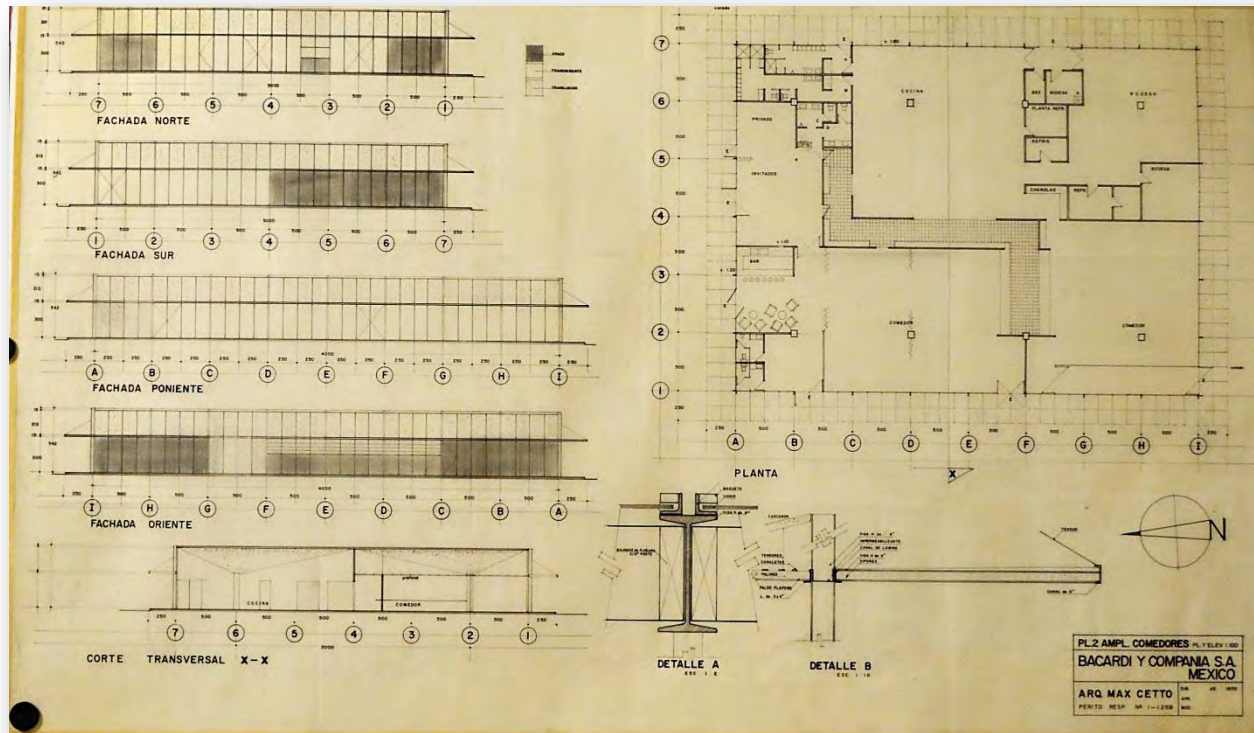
Proyecto Planta comedor y fachadas Arq. Max Cetto
